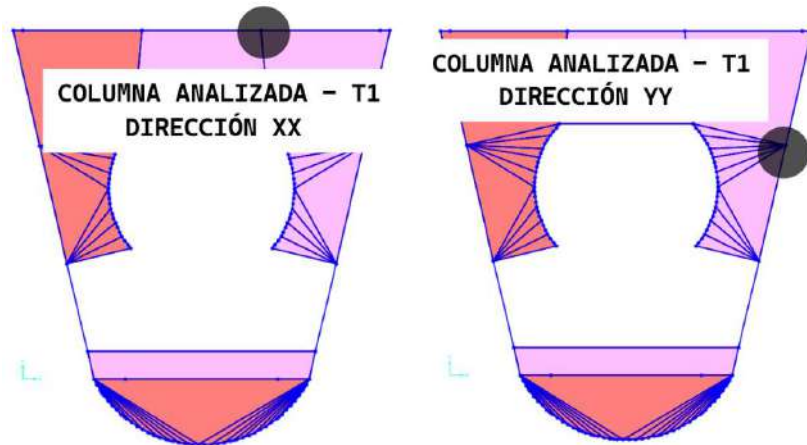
Bloque C: Ubicación de las columnas para el cálculo de la rotación,
